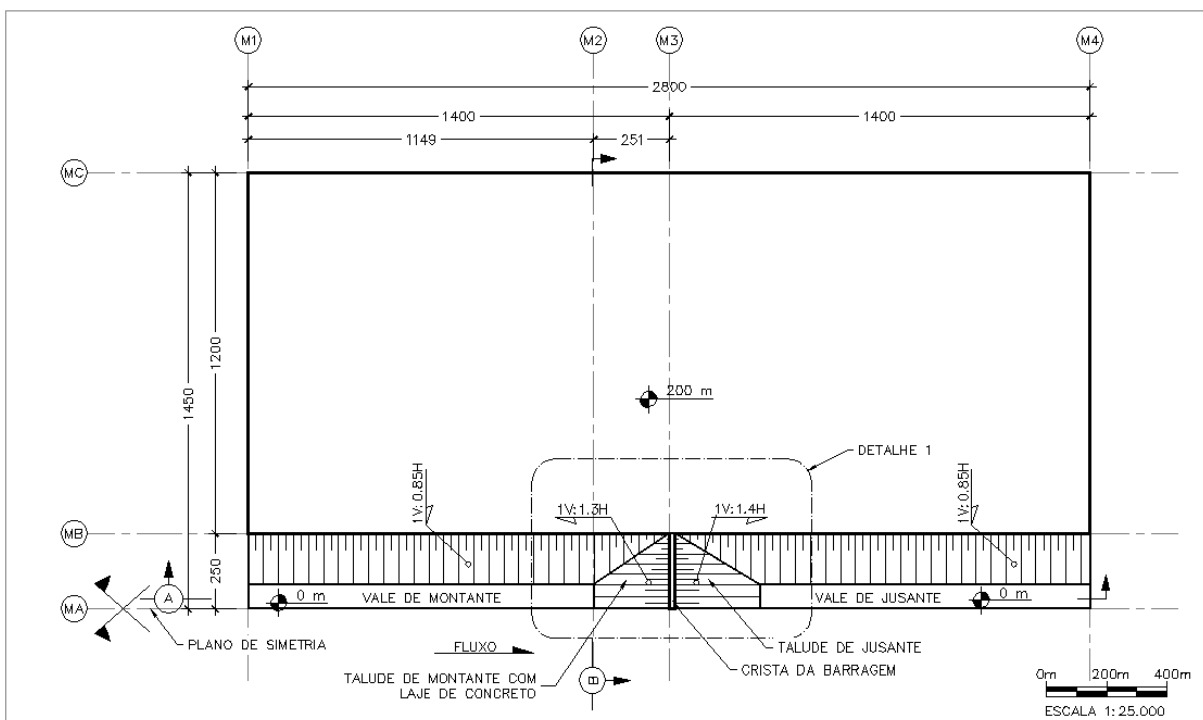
Projeto em planta. Escala 1:25.000.
